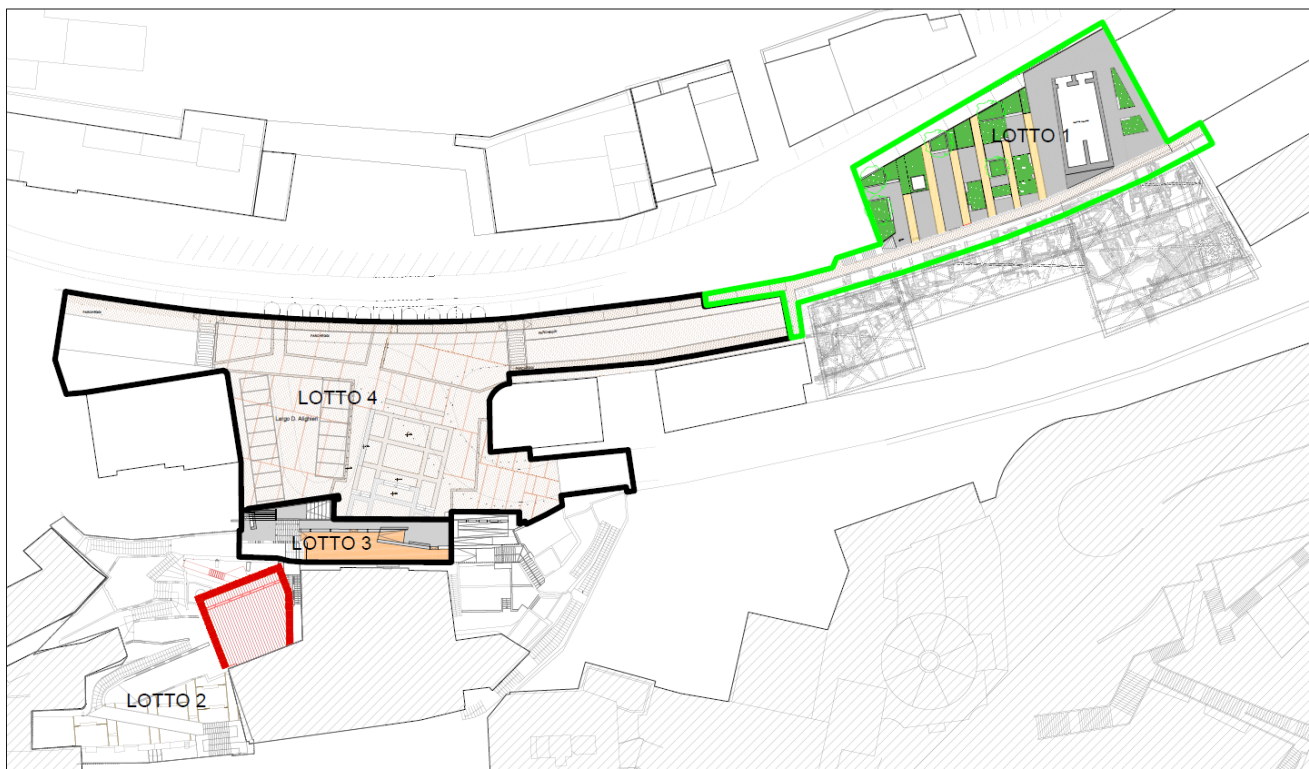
planimetria generale degli interventi di progetto con la divisione in lotti
